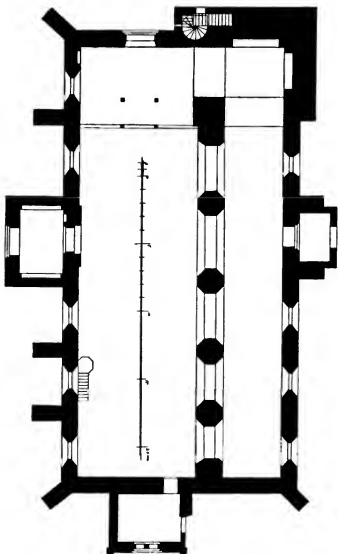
Grundriß der Kirche zu Bühlsaufen.¹⁾
